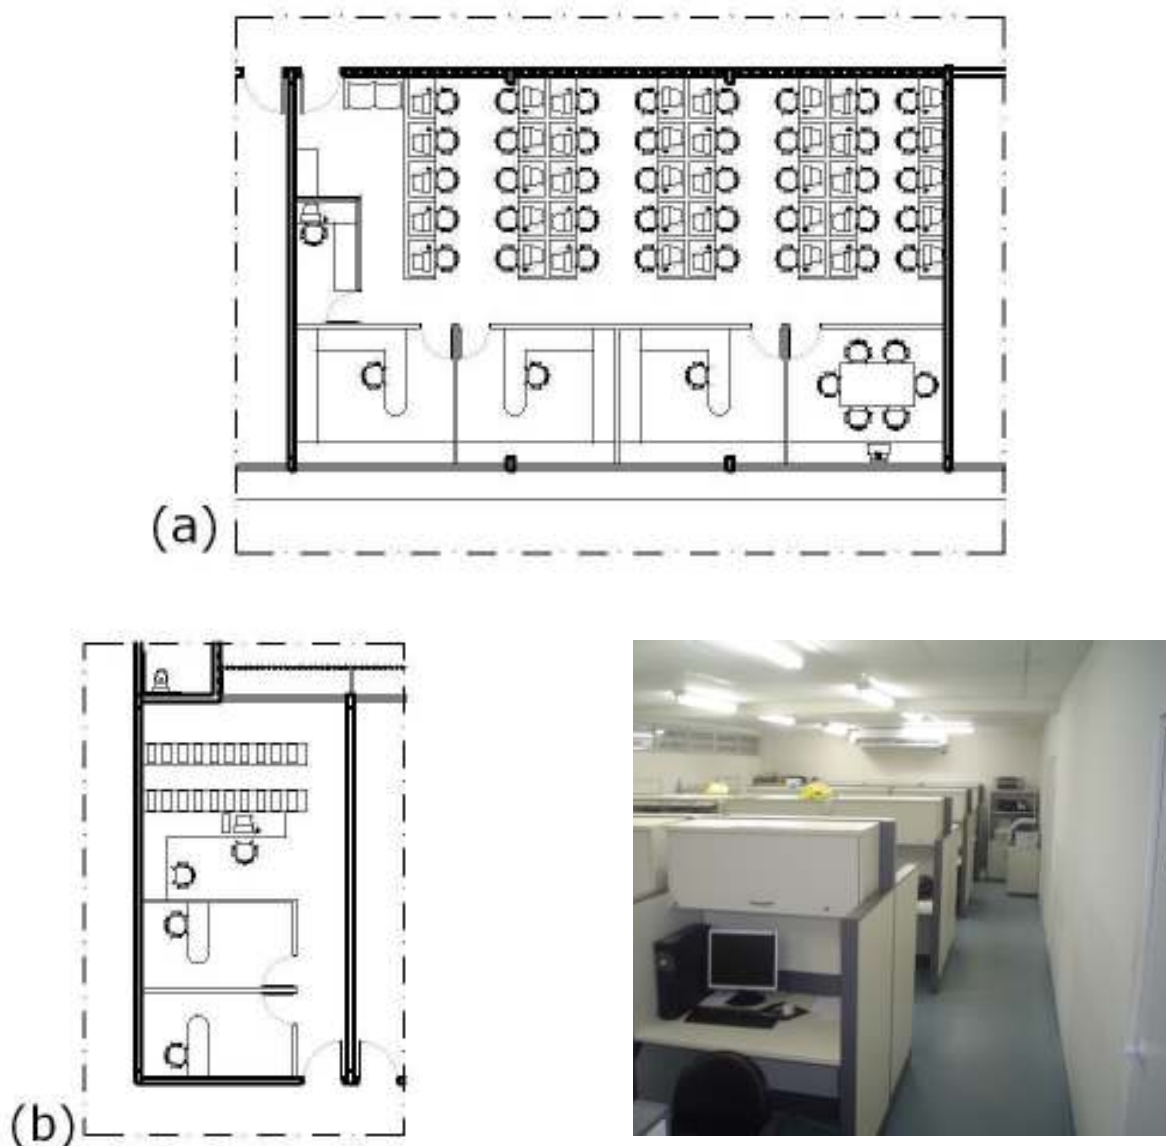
Layout do LCCV (a) e LCAD (b). Foto 5 – Vista interna do LCCV (a).
